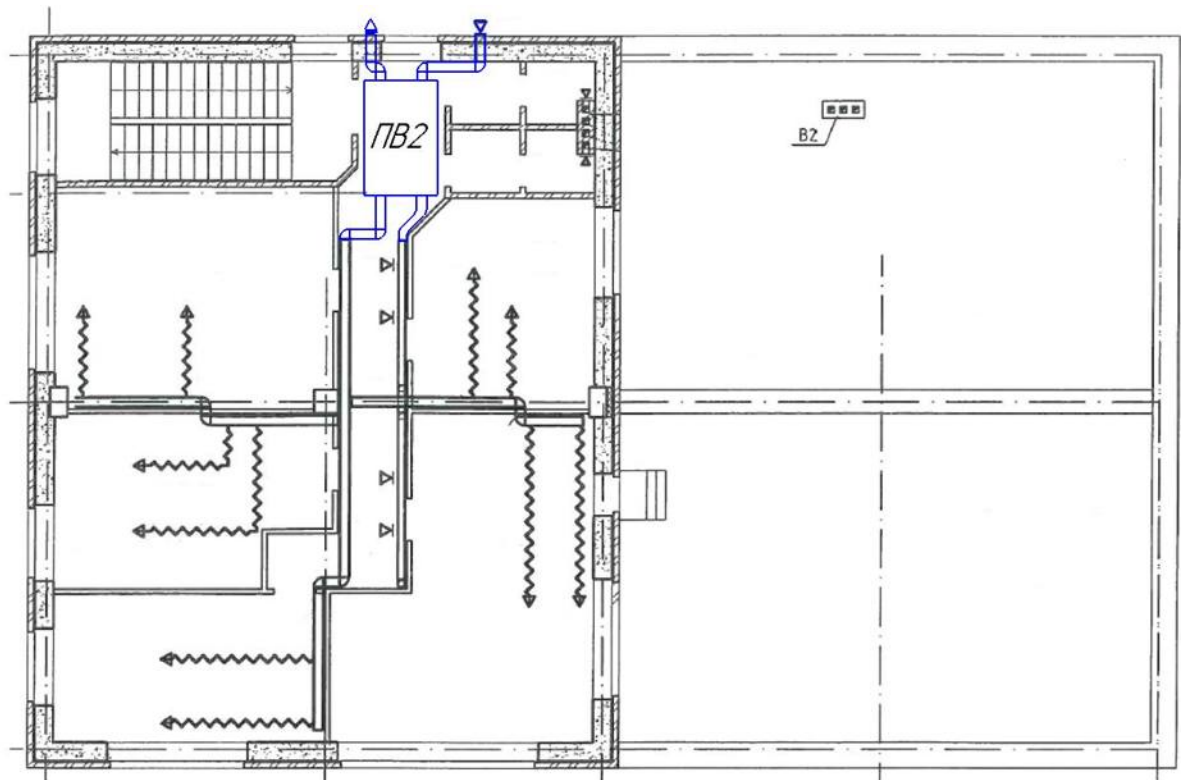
Схема вентиляции второго этажа после внедрения рекуперативной установки
